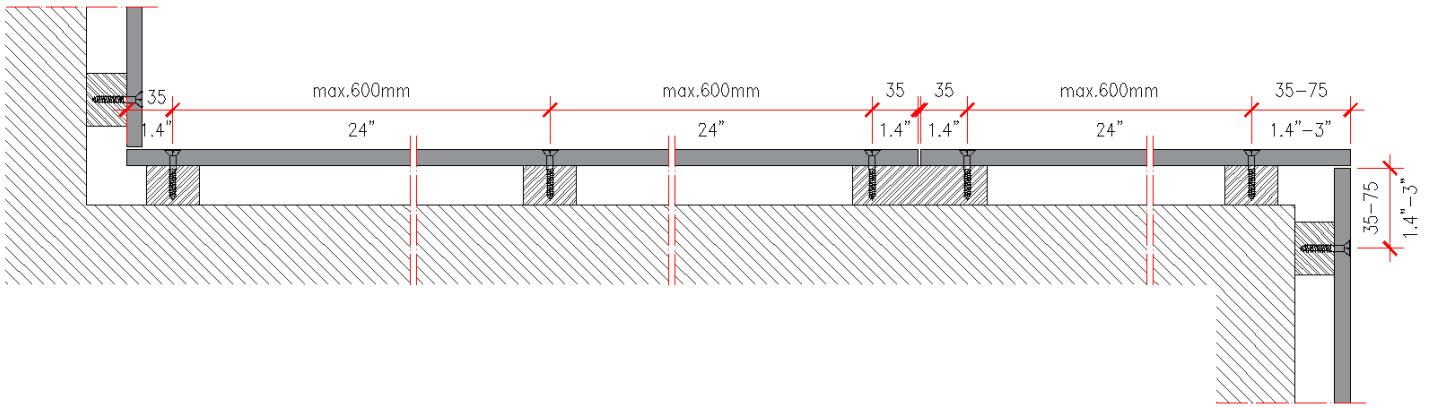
Section horizontale du revêtement mural, structure en bois
